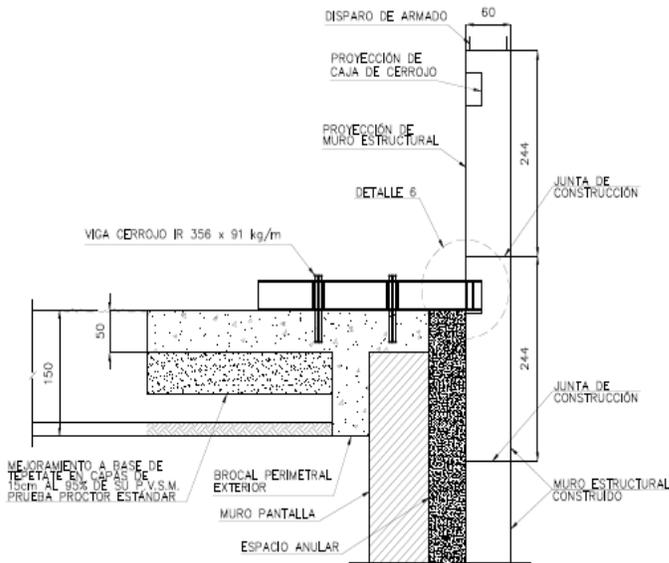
Perfil de colados subsiguientes de muro estructural.
